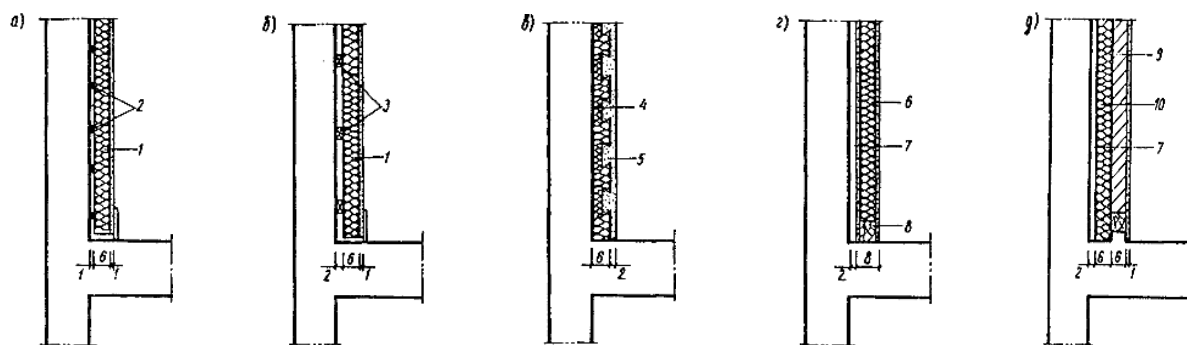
Внутренняя теплоизоляция стен двухслойными плитами, приклеенными непосредственно к стене (а), через прокладки (б), со слоем штукатурки по приклеенному плитному утеплителю (в), с помощью дублирующей перегородки из трехслойных плит (з) и из кирпичной кладки и плитного утеплителя (д):
